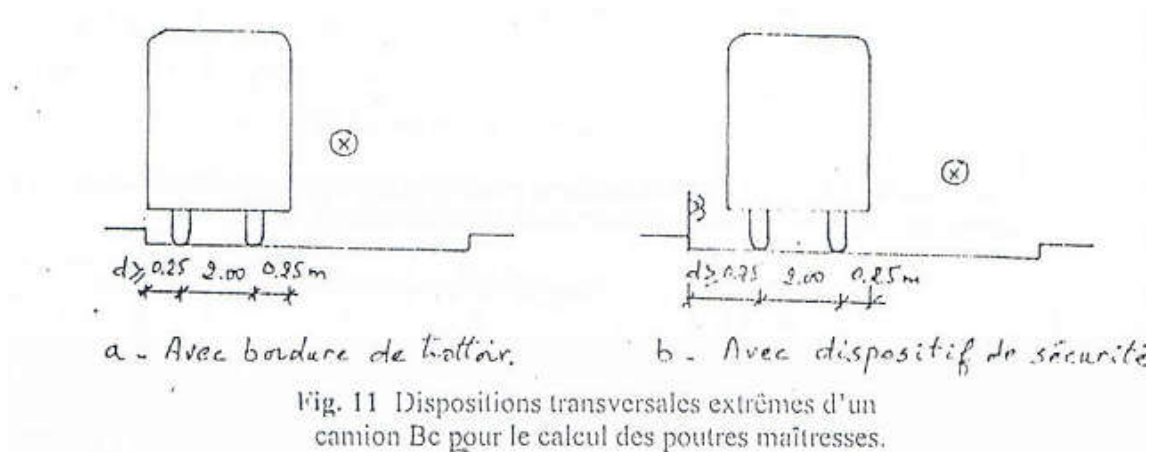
Dispositions transversales extrêmes d'un camion Bc pour le calcul des poutres maîtresses.
